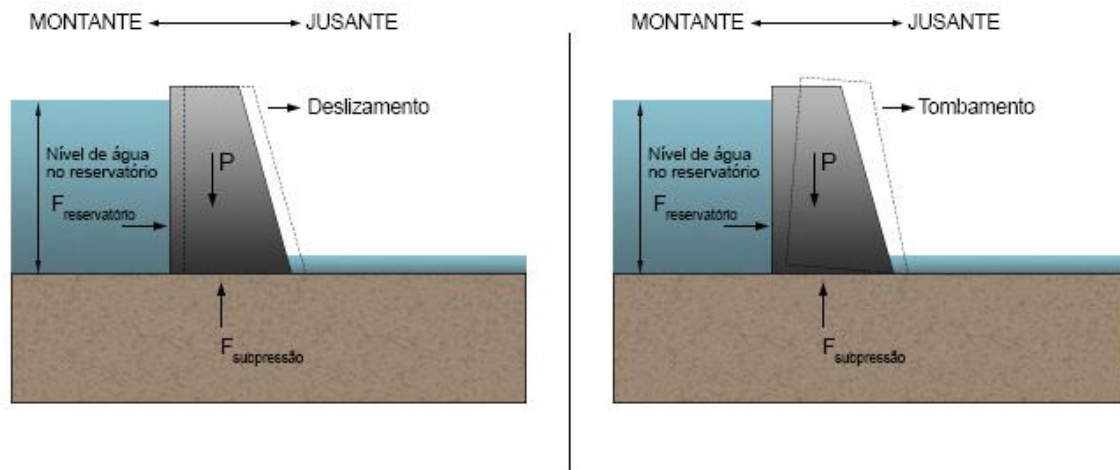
Formas de desinstabilização em uma barragens de concreto
